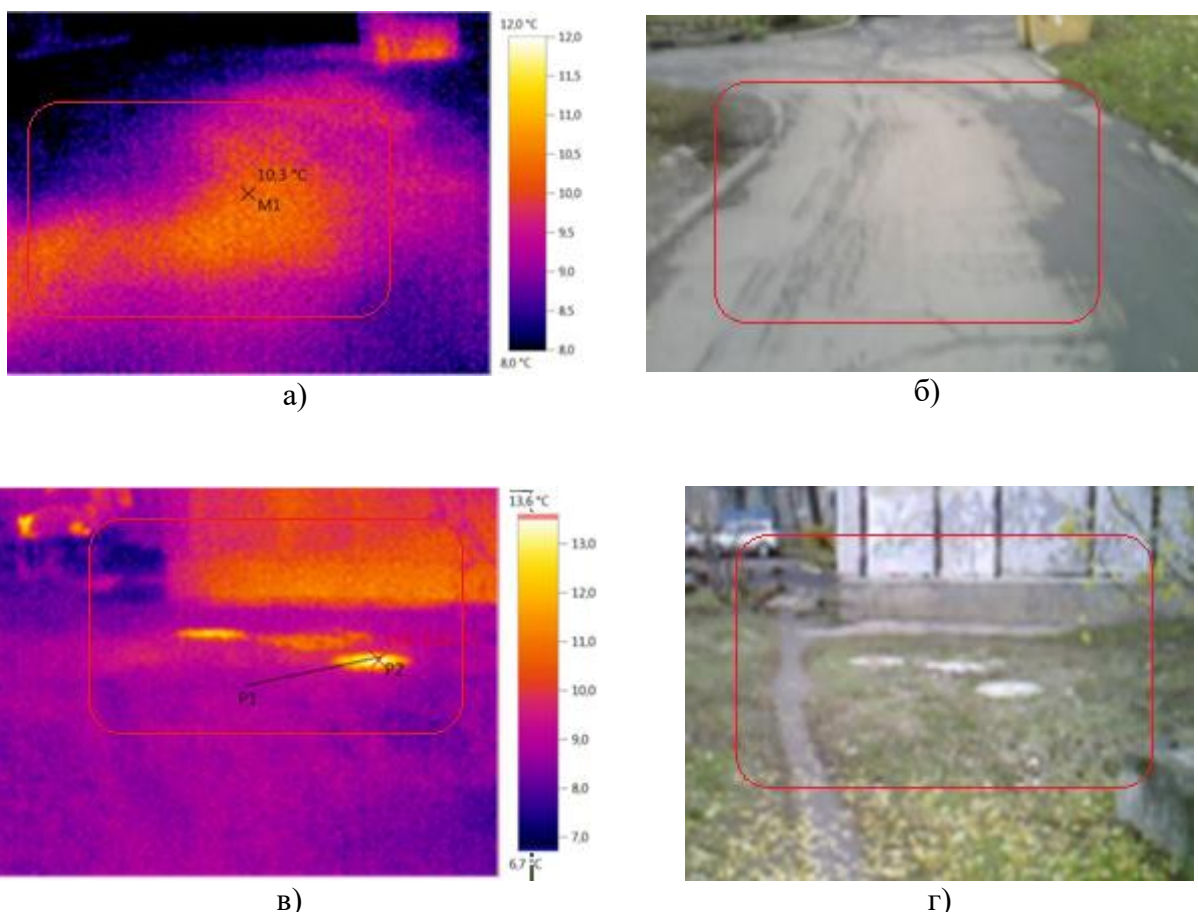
Обследование подземного трубопровода тепловой сети, тепловизором Testo 868 при наружной температуре +3 °C
